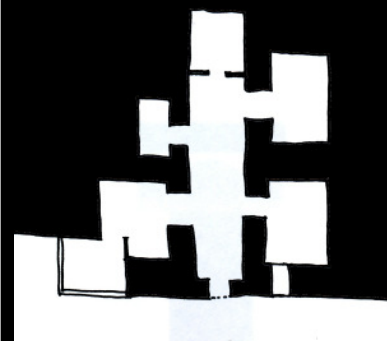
Planta esquemática de habitação subterrânea com acrescentos
